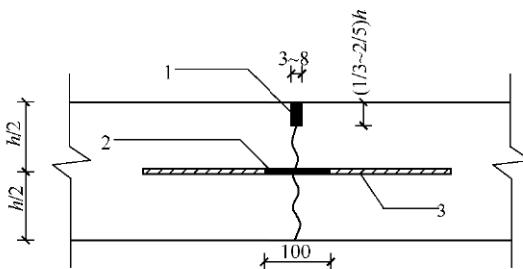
纵向缩缝构造（尺寸单位：mm）
